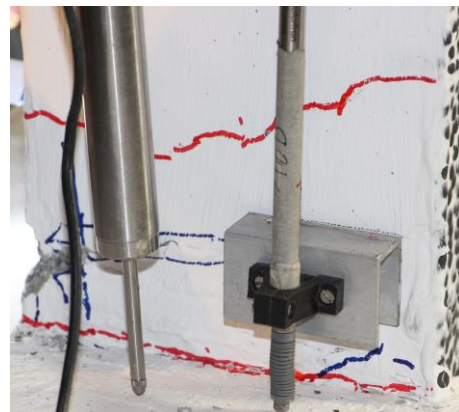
Fissures verticales de compression sur la face latérale gauche de la colonne C3C au LS32
